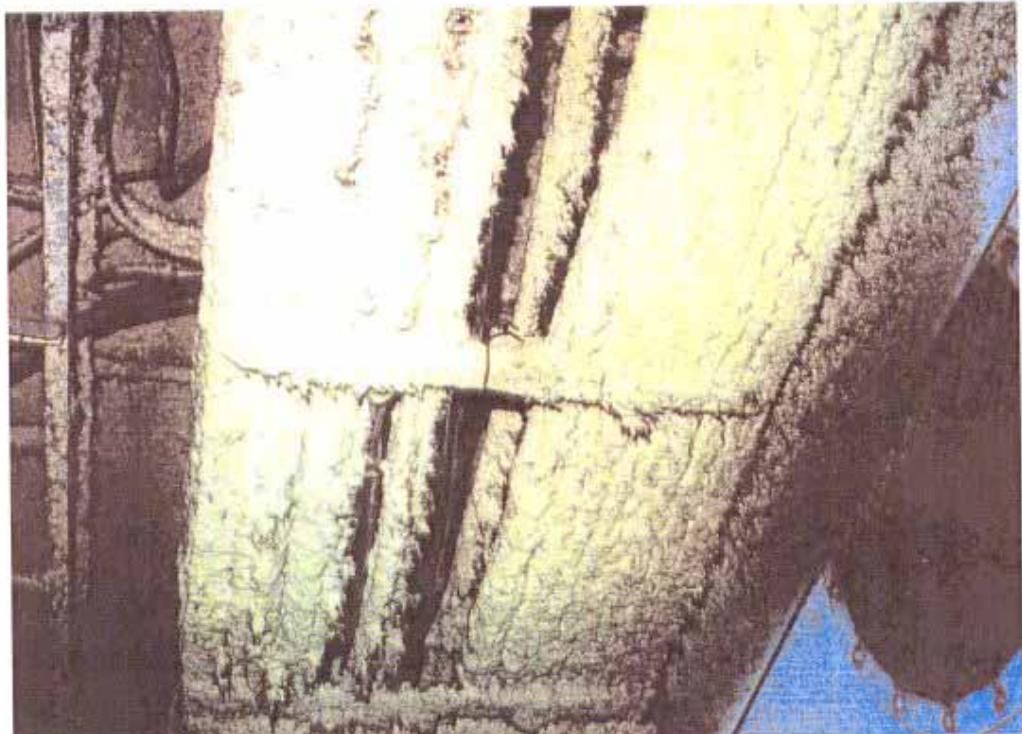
/V – nástrík azbestu – LIMPET – nedopatřením aplikován i na betonovou desku
